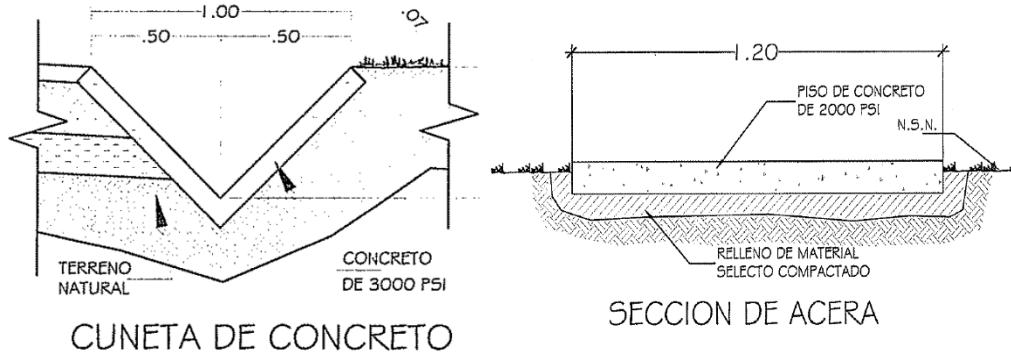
Detalle de cuneta y acera. Fuente: Planos de anteproyecto
